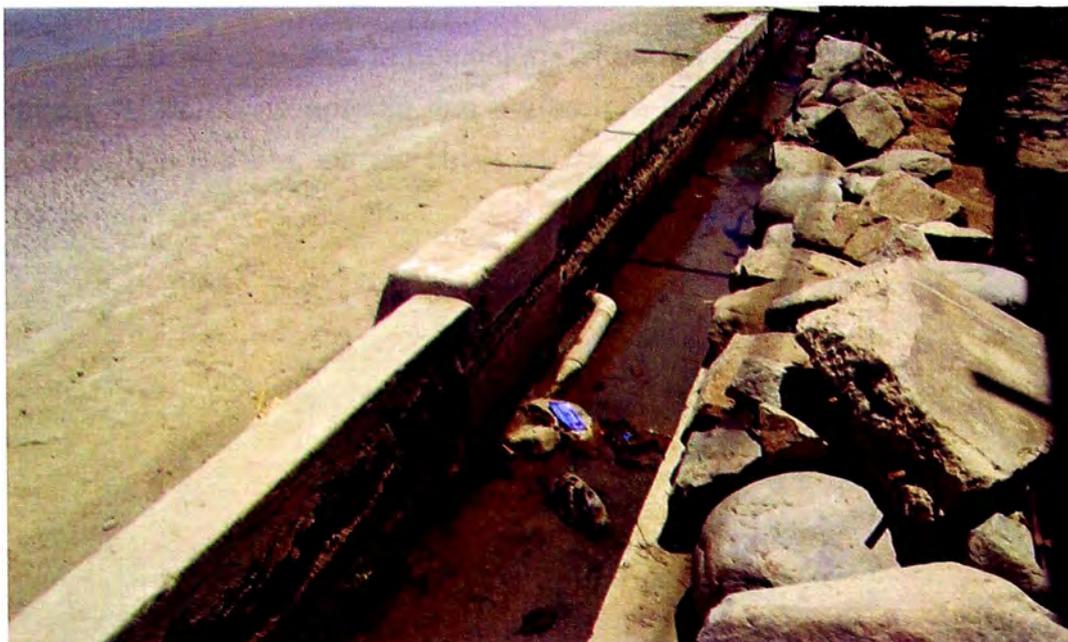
km 33 + 040 Se aprecia el canal de concreto ligeramente obstruido por desechos, piedras y sedimentos.
